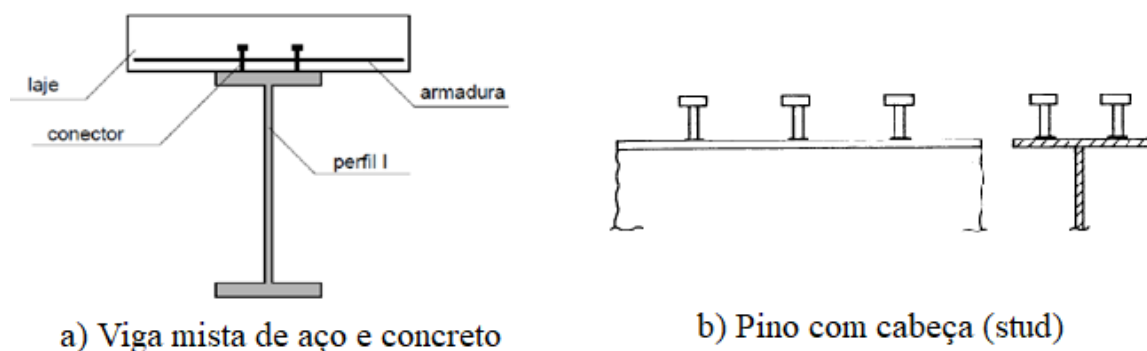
Modelo de uma viga mista do tipo aço-concreto
